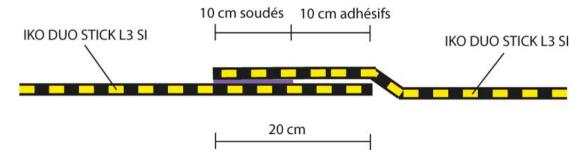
Soudure des recouvrements transversaux sans écran thermique de la feuille IKO DUO STICK L3 SI
